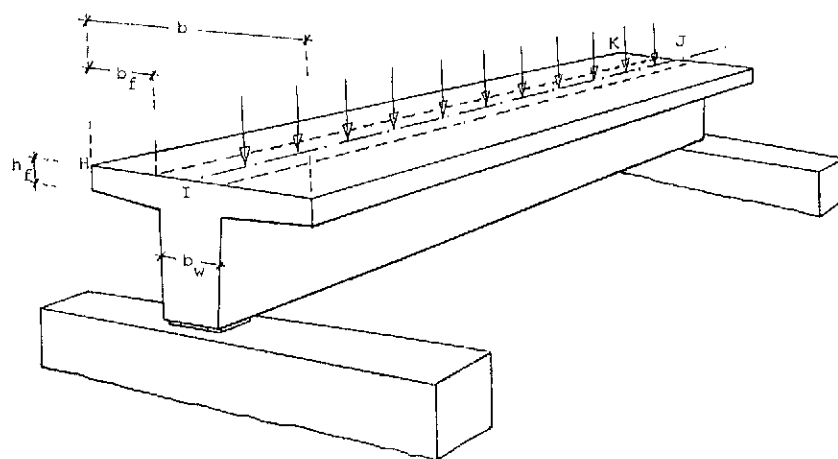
Viga de hormigón, de sección en T, bajo la acción de una carga aplicada en la anchura b_w del nervio.
